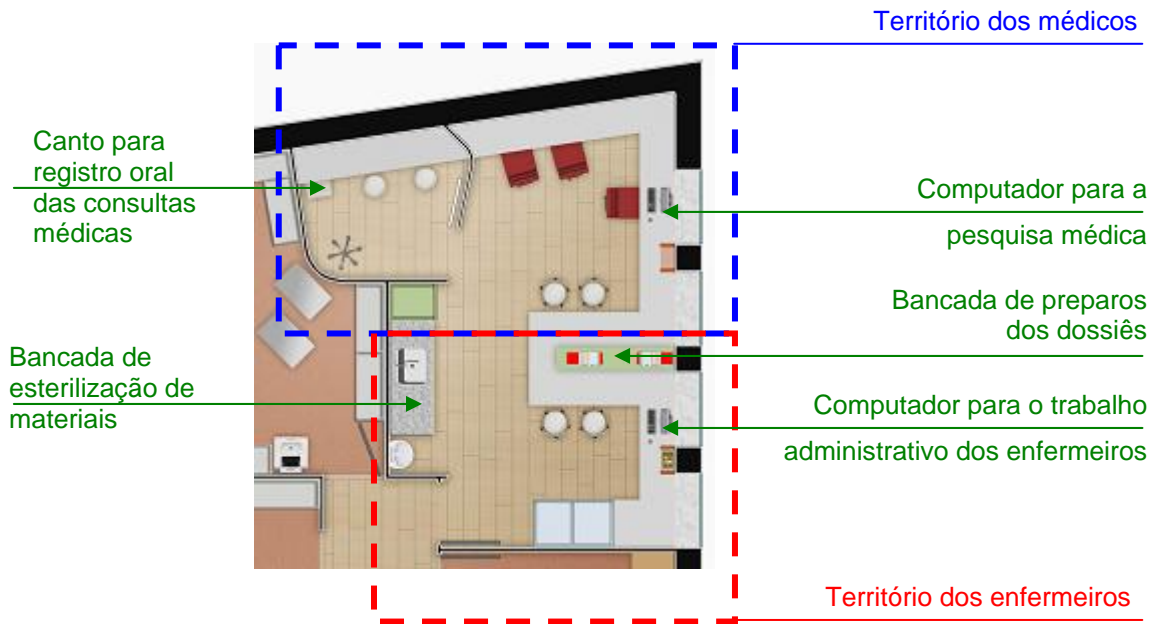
Planta sala de preparos, posterior ao projeto (2º pavimento), dividida em dois territórios
